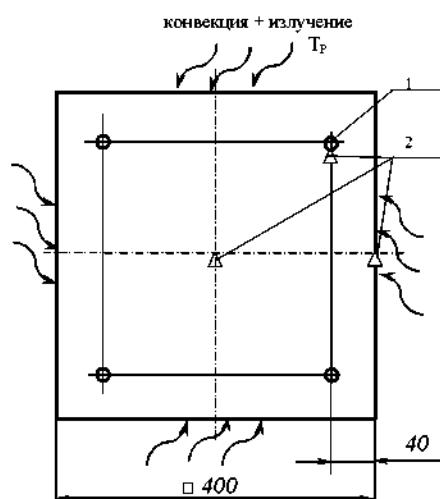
Конструктивная схема сечения испытуемой железобетонной колонны:
